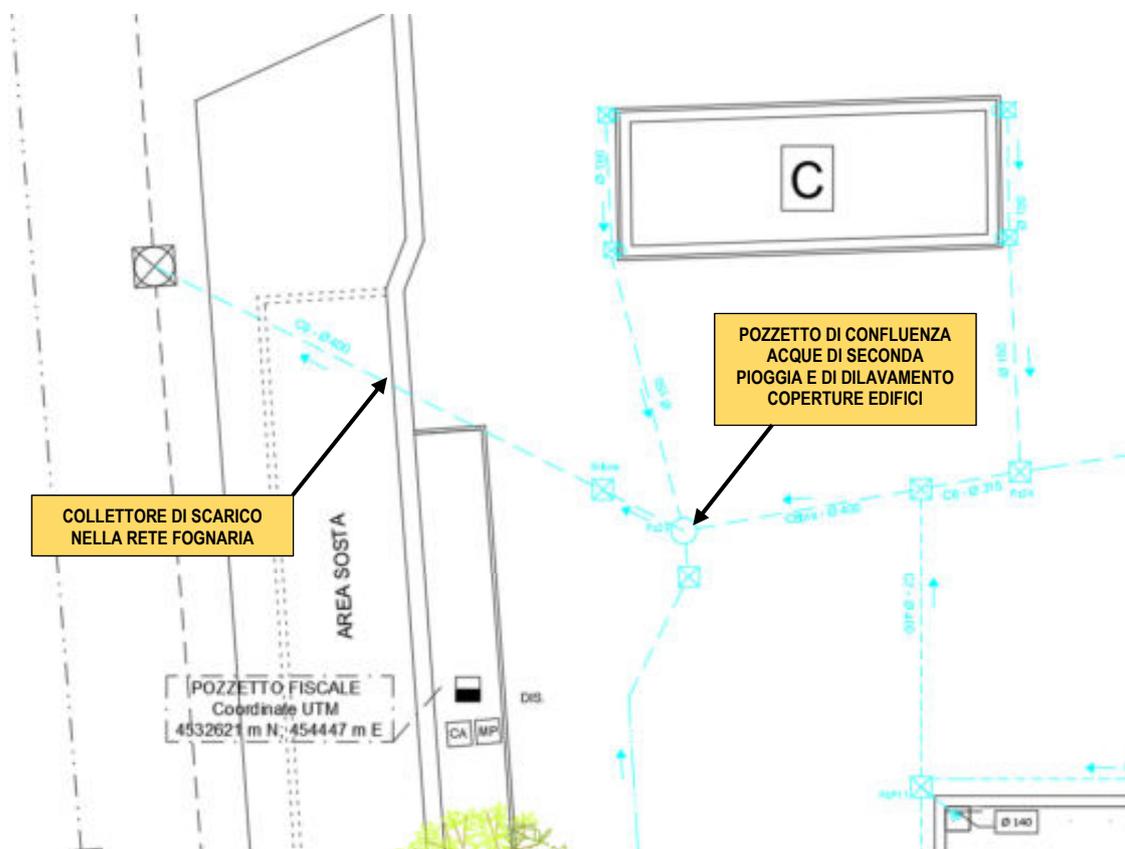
Stralcio planimetrico impianto di allontanamento acque di seconda pioggia di dilavamento dei piazzali e acque di dilavamento coperture edifici
